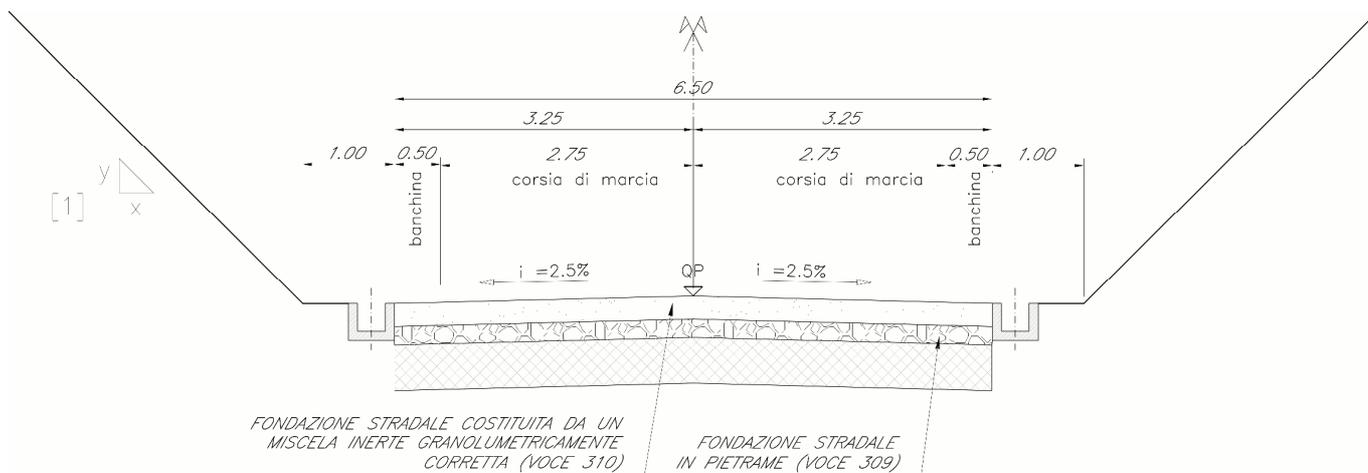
SEZIONE TIPO IN TRINCEA CON PAVIMENTAZIONE IN MACADAM
